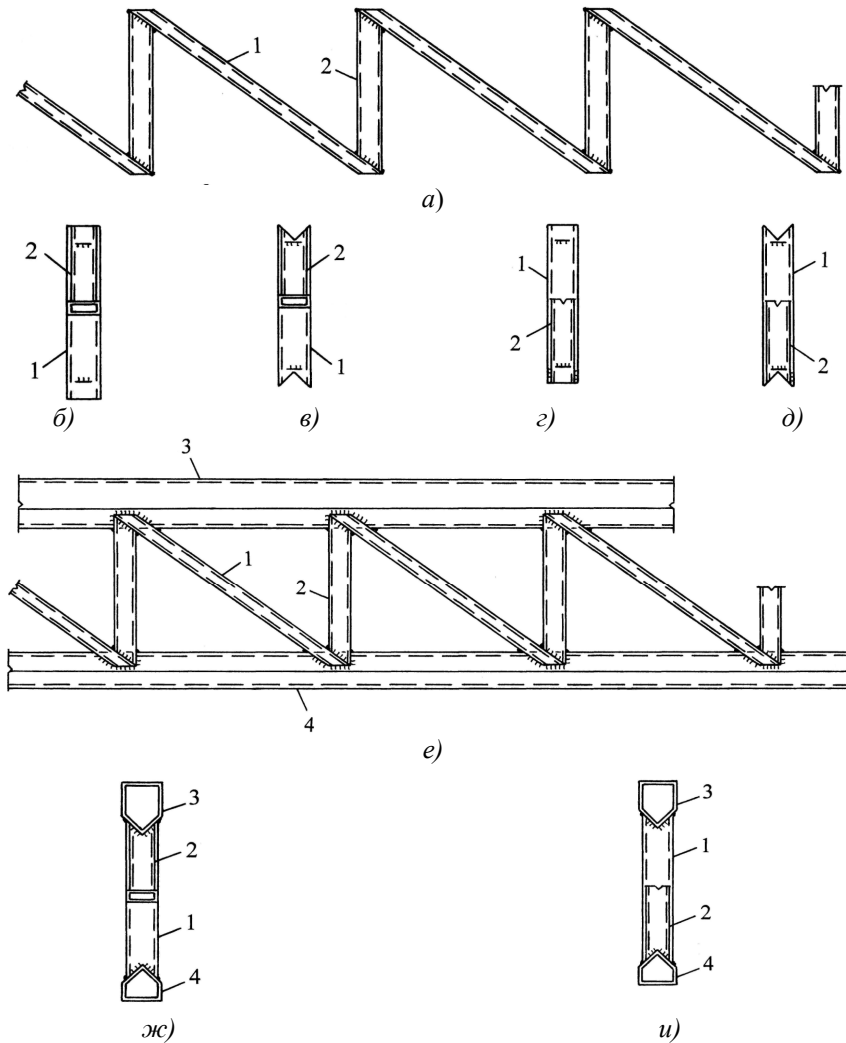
Схеми изготовления конструкции с решеткой раскосной системы:
